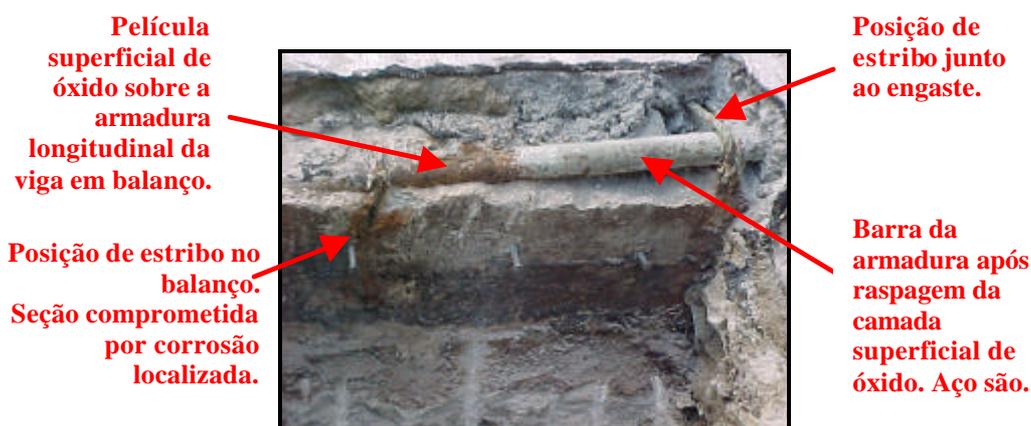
Verificação da integridade estrutural do aço dentro de viga de marquise.
